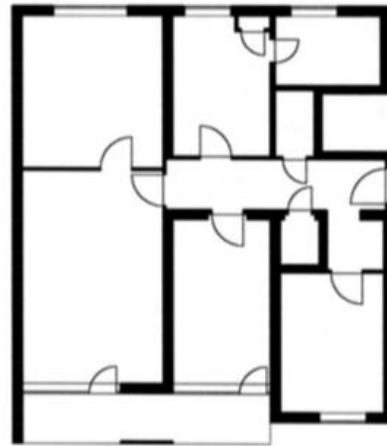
Grundrissbeispiel Dr.-Robert-Graf-Strasse
